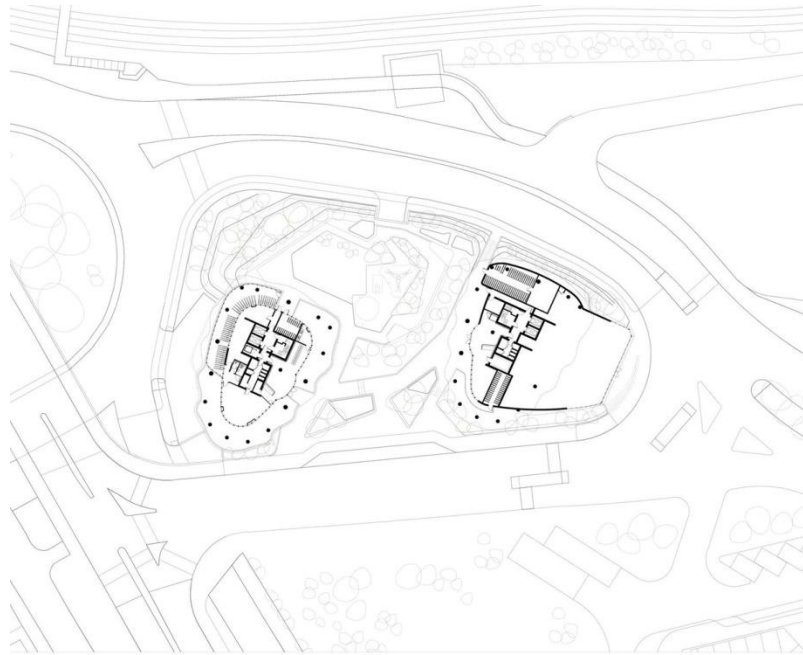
План підземного поверху[10] Рис. 2.10.3 План першого поверху[10]
